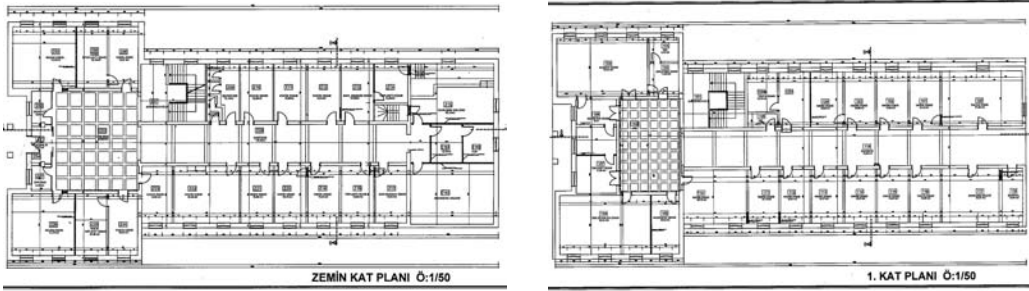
Gar Binası Yarışması'nda birincilik alan projenin planları
